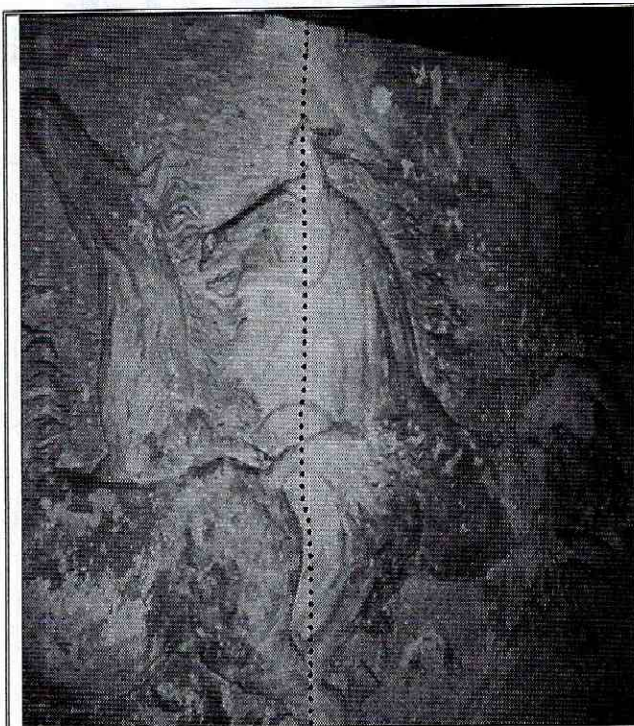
Fisura de tendencia diagonal identificada en muro de cerramiento de la vivienda ubicada en el predio de la Carrera 46 No. 103 A – 13, en el Barrio Catastral Estoril de la Localidad de Suba.
